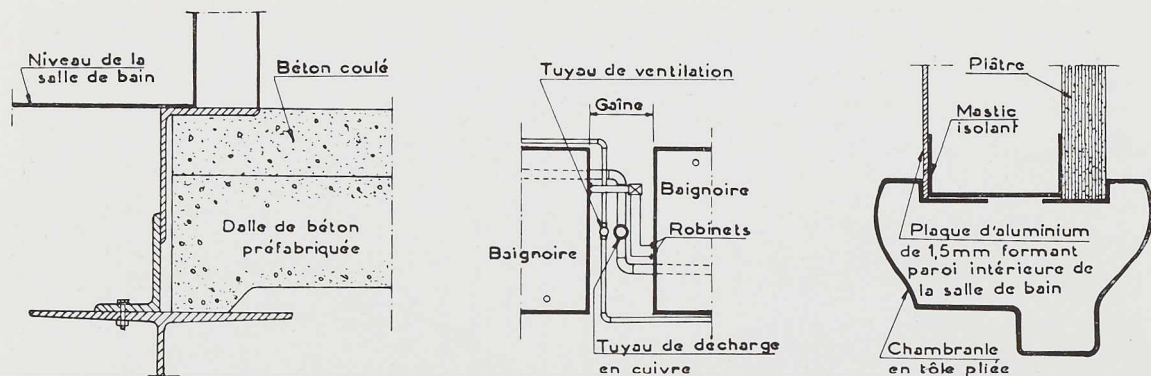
à 784. Détails d'appui du plancher, de la gaine entre la salle de bain et de la pose d'un encadrement de porte
